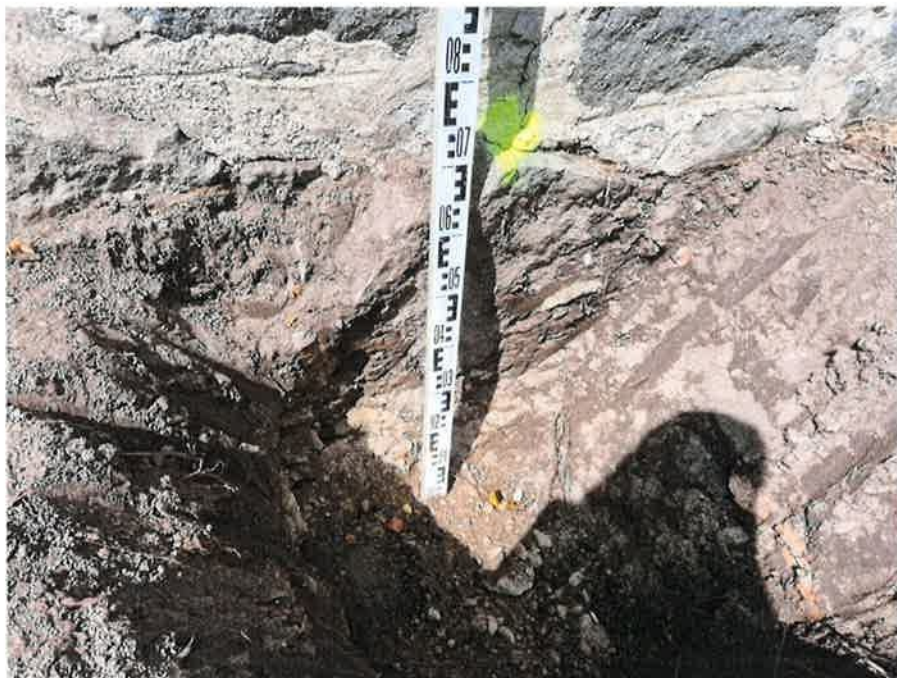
Detailaufnahme Schürfgrube Sch3
